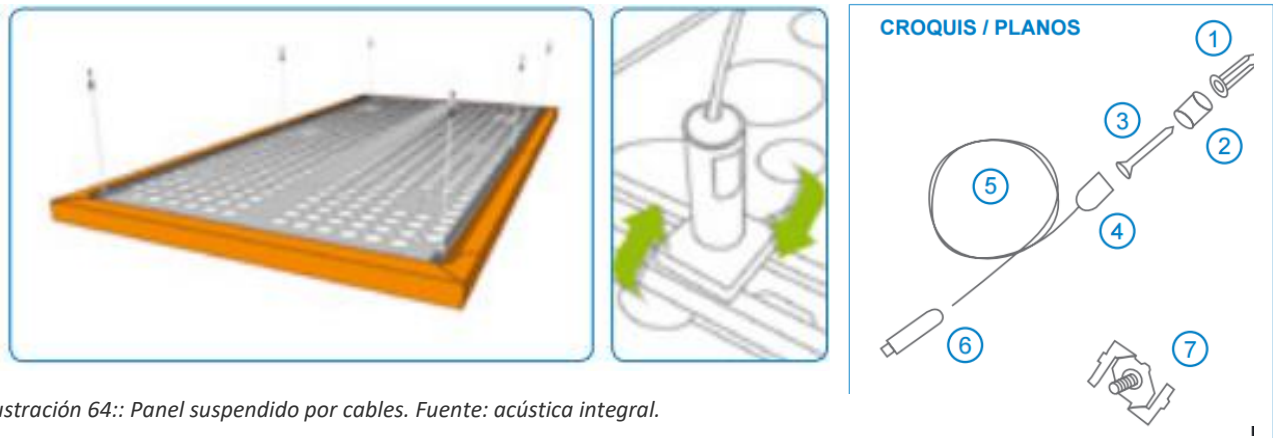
Panel suspendido por cables. Fuente: acústica integral.
